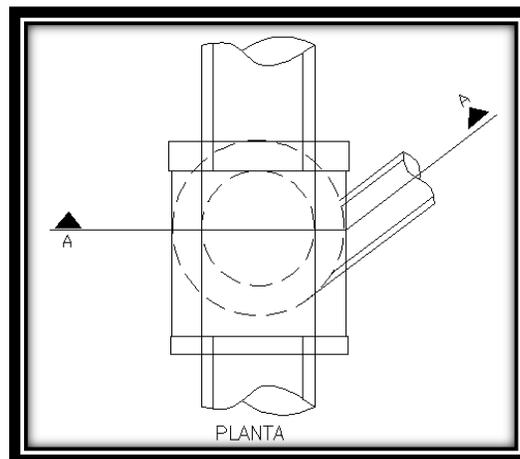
Diseño en planta para pozos de caja de visitas, (Ref. 1)
